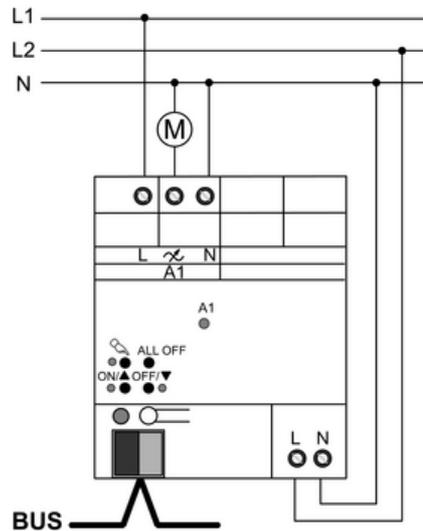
1-составный исполнительный элемент управления – подключение для работы в качестве устройства регулировки числа оборотов
